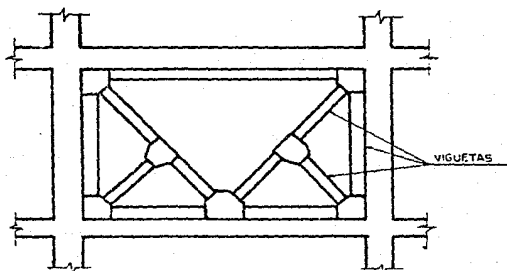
Alternativa de contraventeo con perfiles metálicos.
